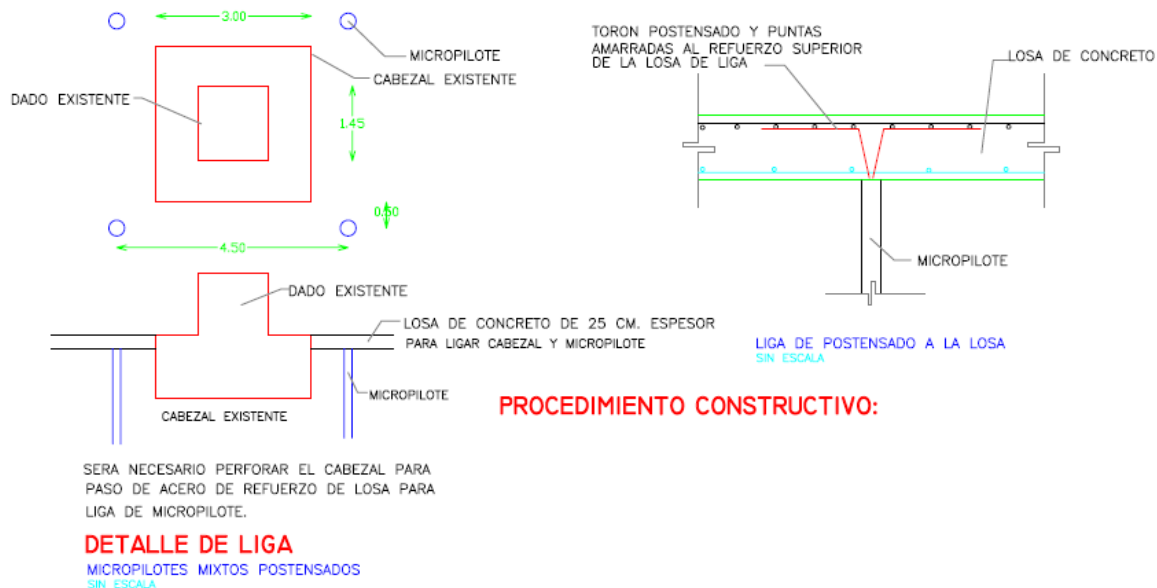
Detalle de armado y procedimiento constructivo de los micropilotes.
